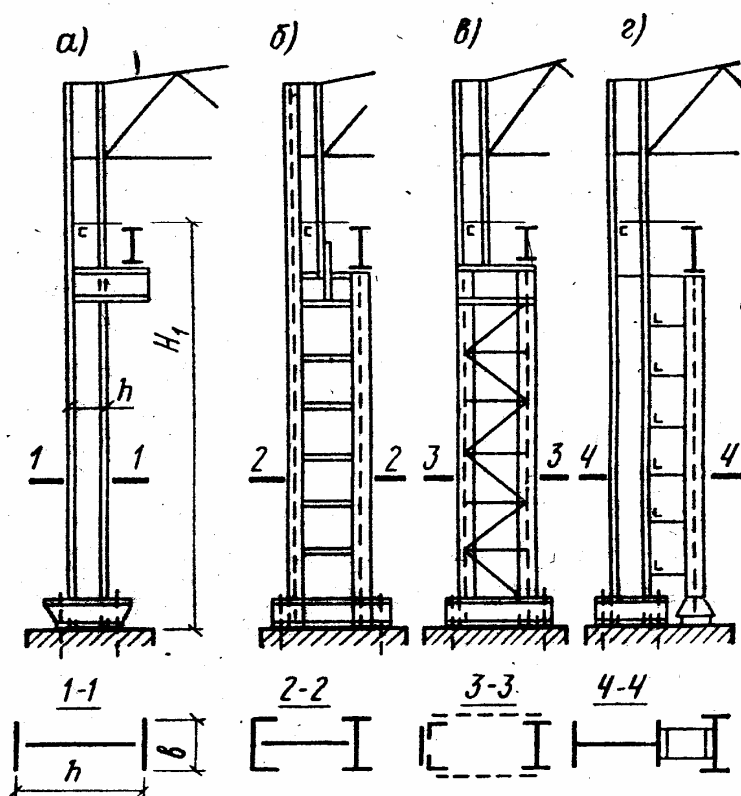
Схемы внецентренно-сжатых стальных колонн
